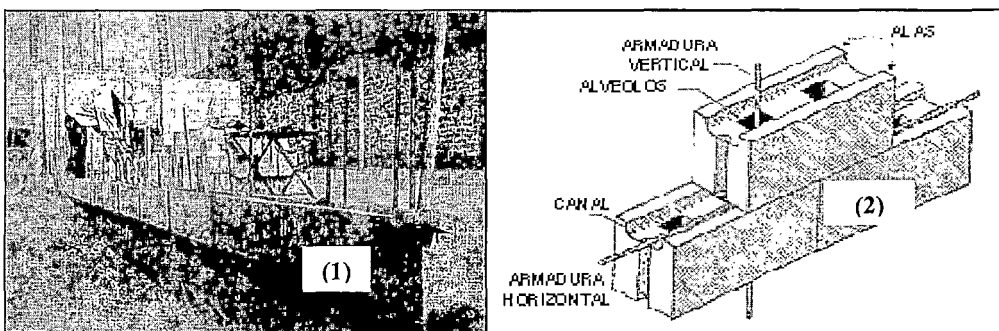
BLOQUETA DE CONCRETO (1) Y LA UNIDAD SILICOCALCAREO (2).
